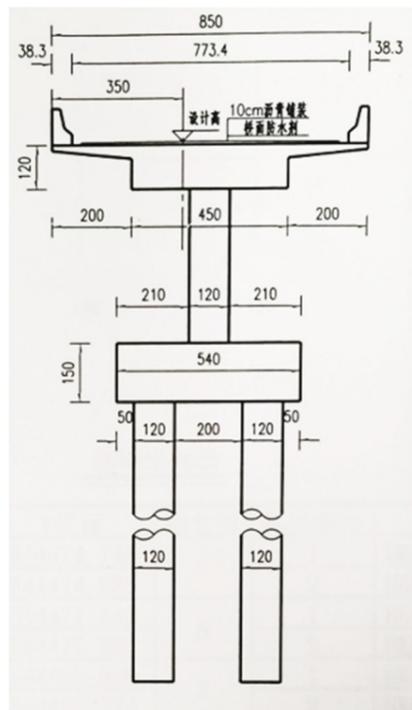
H 匝道桥剖面图 (桥墩处)
